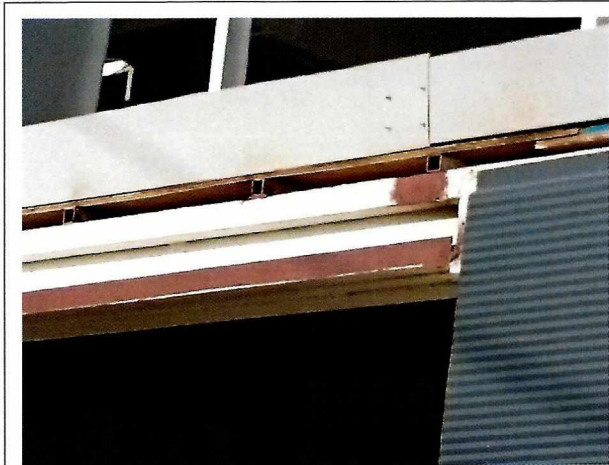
12/05/15: Elemento a la vista entre los ejes 17 y A8, de la planta de fundaciones Plano N°10151-G-07.
